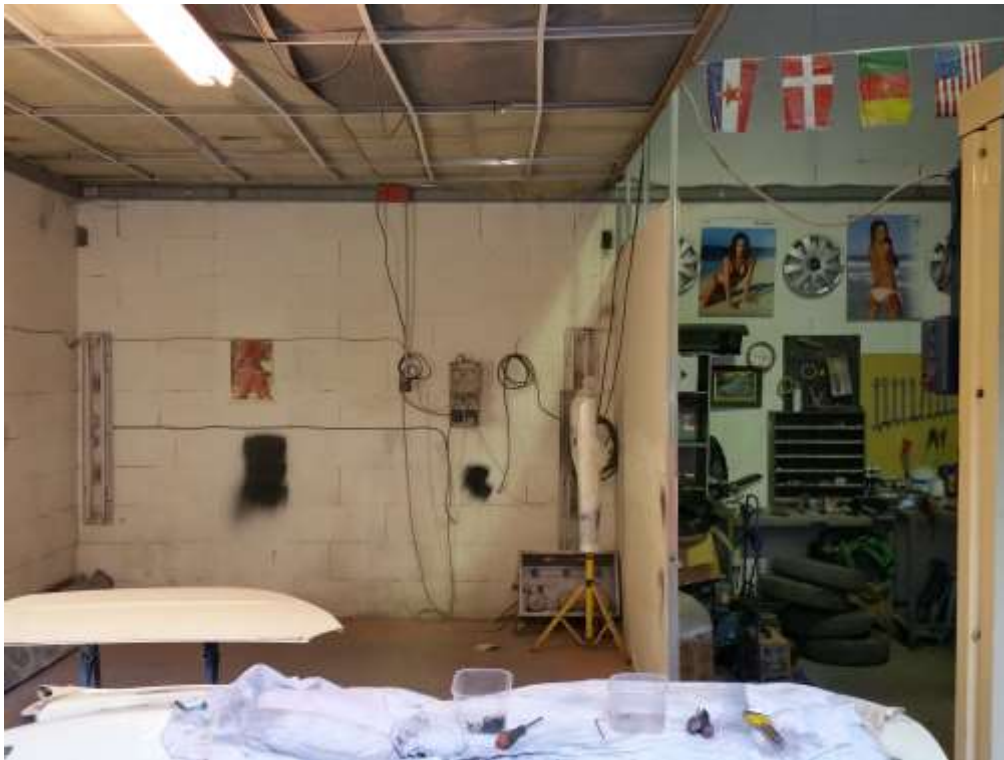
LOCALE "5" COLLEGATO ALL'UFFICIO
